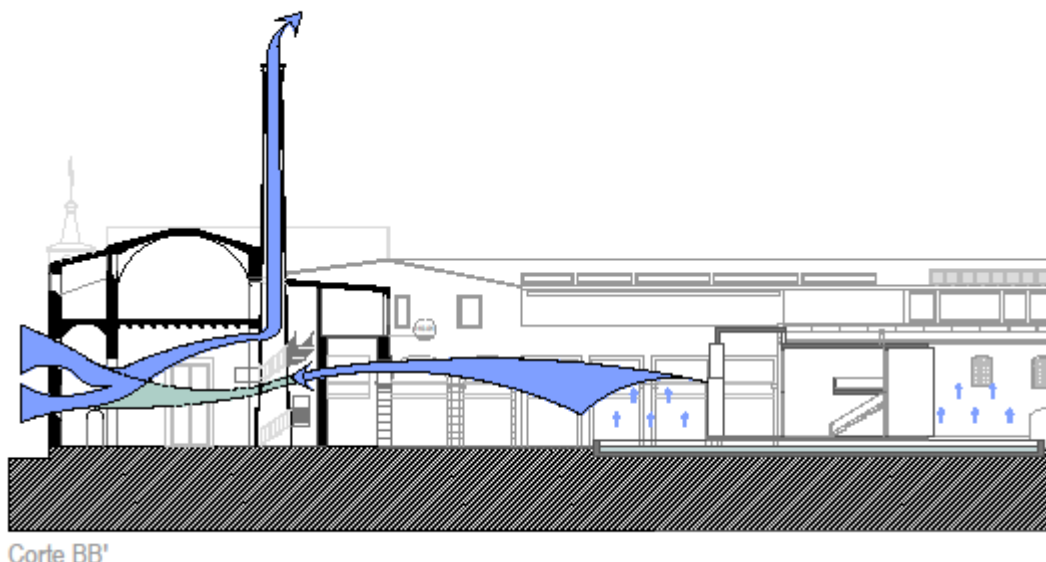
Corte Esquemático do tipo de ventilação utilizada
